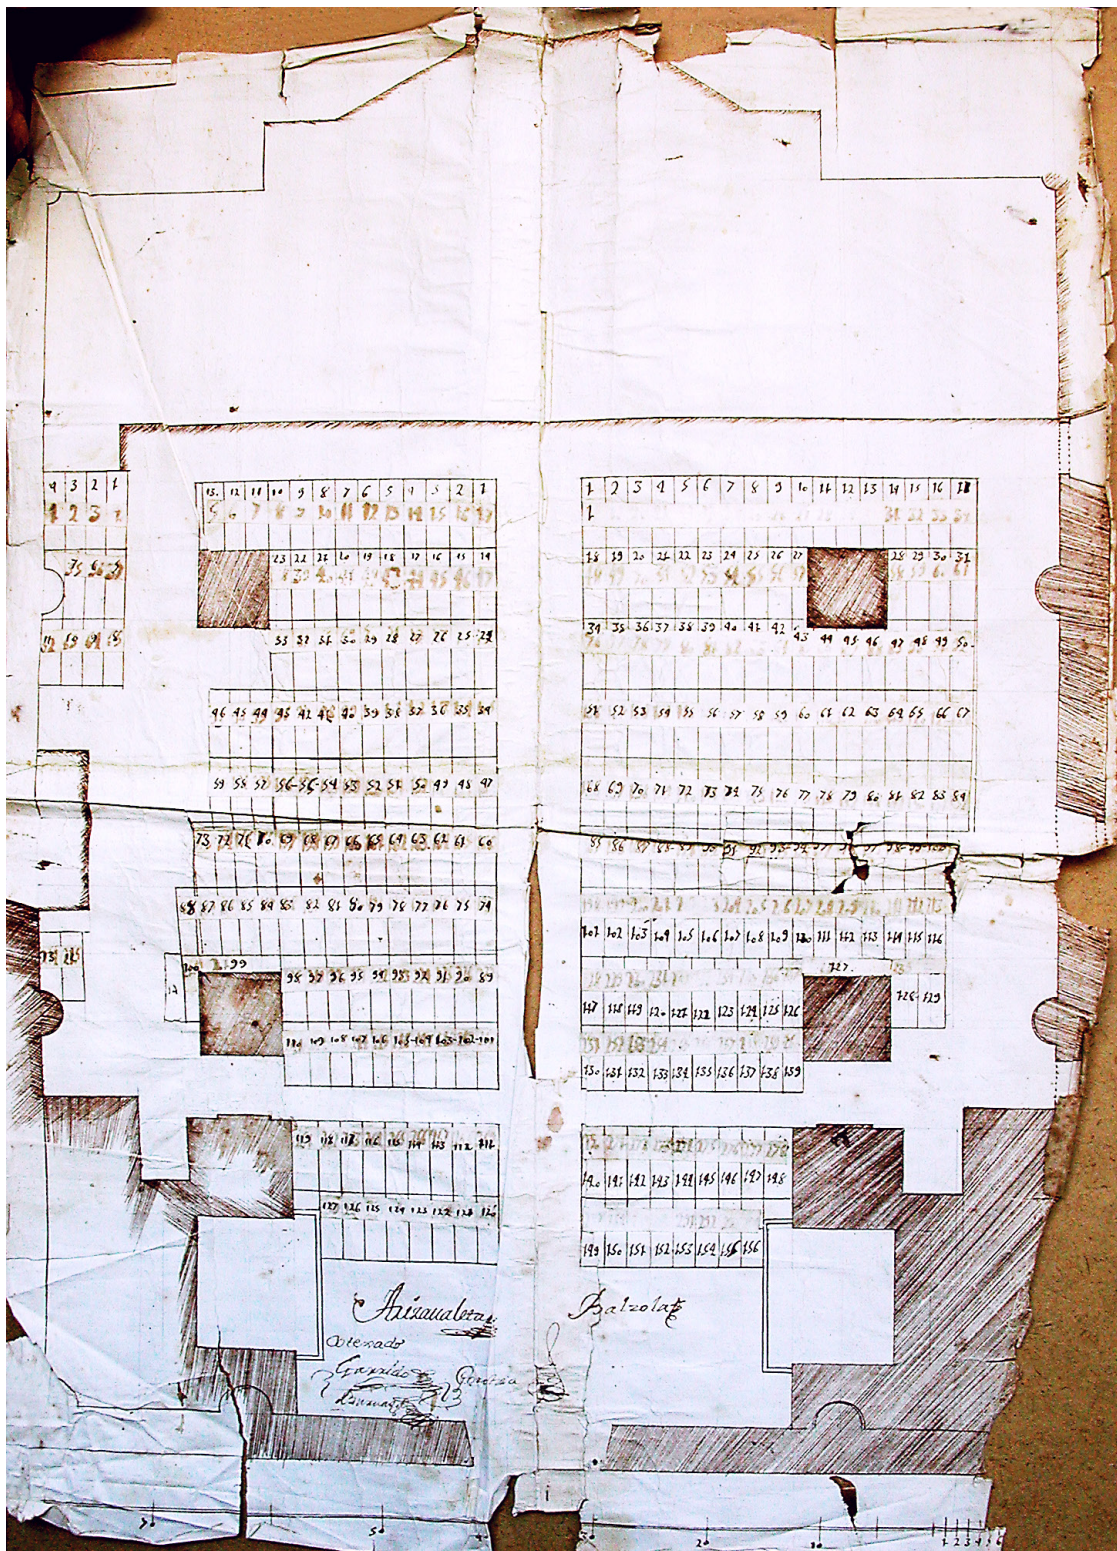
Plano levantado en el año 1751 por Arizabaleta y Balzola, que refleja la estructura organizativa del cementerio intraeclesiástico de la iglesia parroquial de la Purísima Concepción de Elorrio, en fecha previa a su renovación. Podemos observar su extensión y alcance sobre el suelo de las naves del templo, así como la organización reticular de calles e hileras que mantienen las sepulturas (Archivo Foral de Bizkia. Fondo Municipal. Subfondo Elorrio. Signatura 3505).
